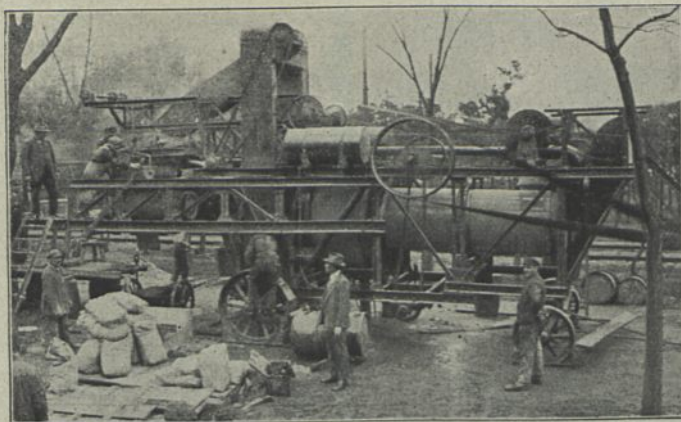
Straßenbaumaschine, die am Tag 200 m Walzasphalstraße herstellt.
